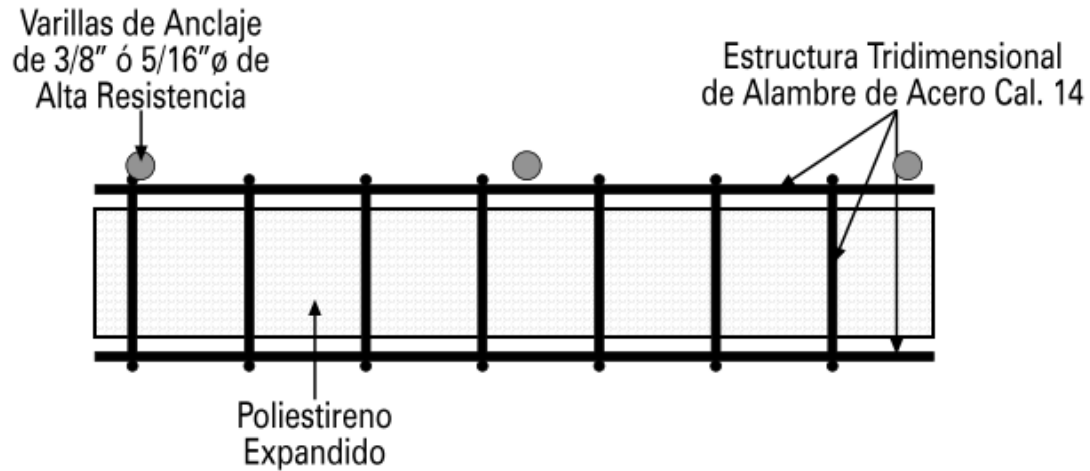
Anclaje del sistema Covintec a cimentación (Planta).
